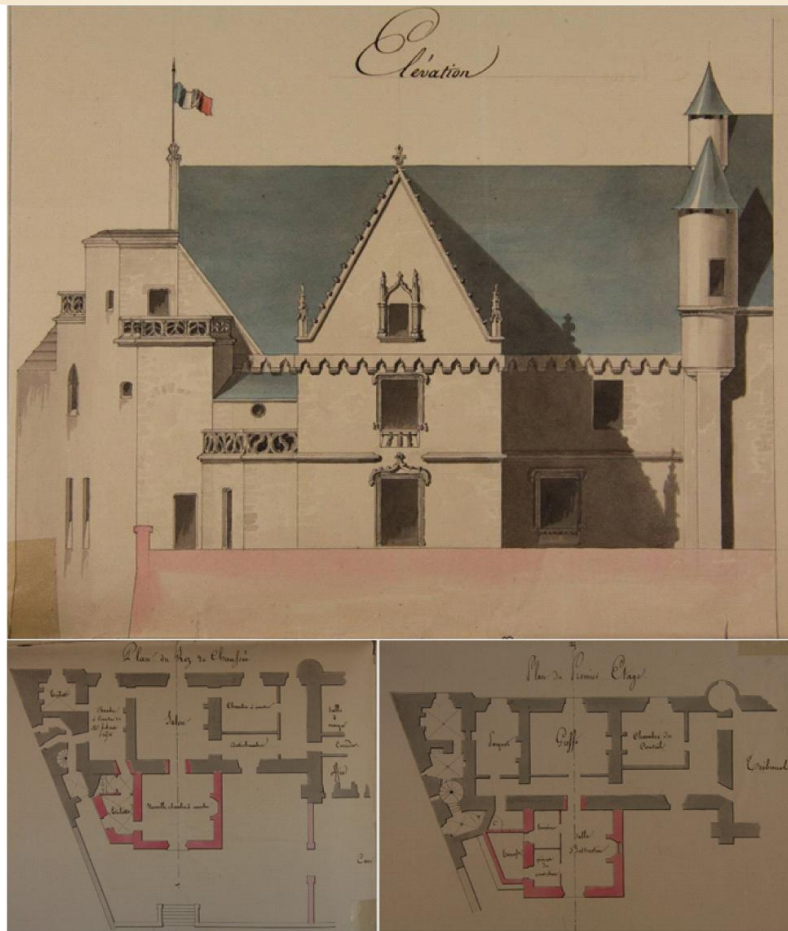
Alfred Pescherard, *Plans, coupe en élévation d'un bâtiment civil à construire sur la face occidentale du château de Loches pour l'agrandissement de la sous-préfecture et pour l'établissement d'une salle d'Instruction*, 25 juin 1834 (ADIL, 4 N 165 - clichés S. Bourrocher).
